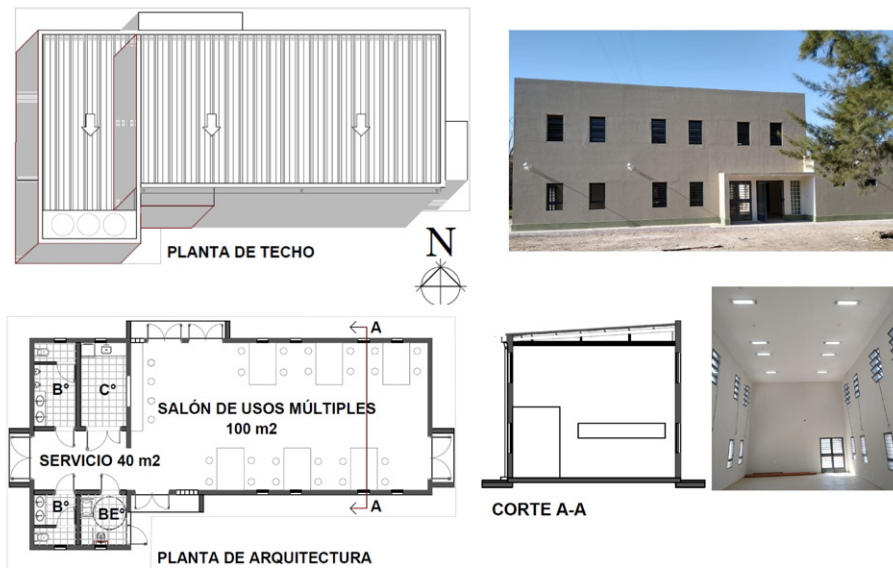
| Planimetría de SUME y fotografías de vistas exterior e interior. Fuente: elaboración propia y fotografías tomadas por el equipo de trabajo.
